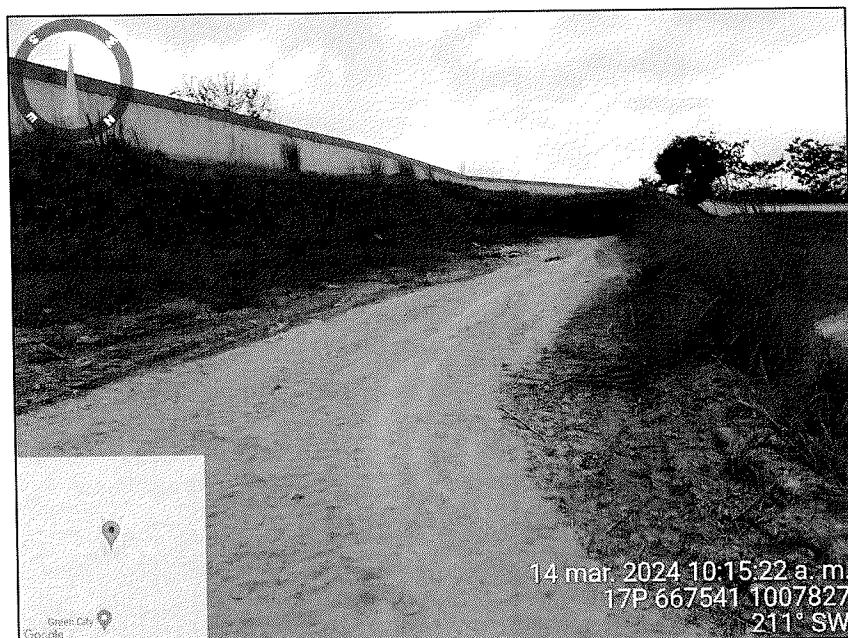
Vista lateral del área de construcción de los Modelos Aquamarina Luxe.
